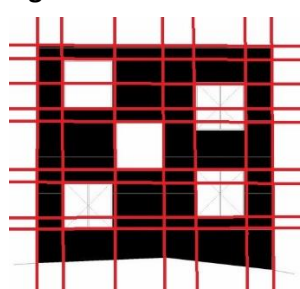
Ceconato. Trazado modular. Pezo Y Von Ellrichshausen. Casa Poli (2005). Casa Poli. Estructura geométrica modular irregular de campo de fachada oeste. En el caso de la lámina plana y rígida de la casa Poli estas estructuras permiten organizar los ahuecamientos, ya sea de forma regular o irregular. Estas estructuras⁶ permitirán ordenar ahuecamientos aislados o regiones ahuecadas (Fig. 34) en base a estructura modular irregular de los propios configurantes espaciales- materiales.
